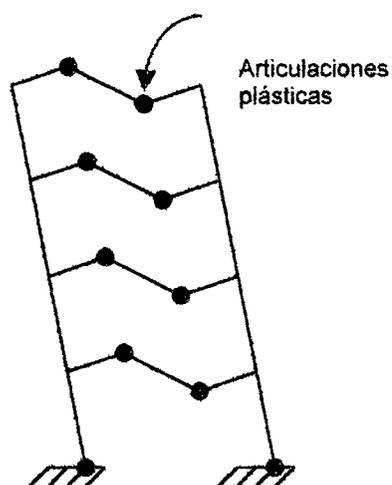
Mecanismos de falla de dos muros acoplados por una hilera de vigas.
